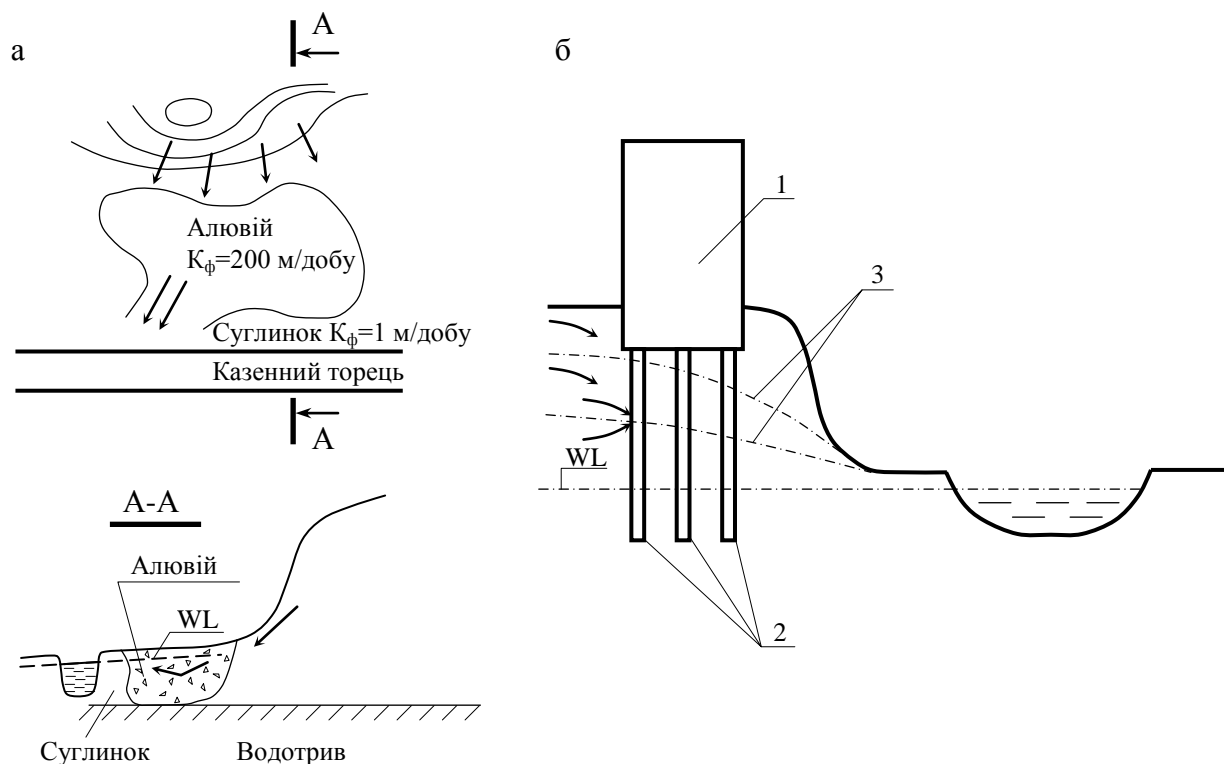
Схеми підтоплення територій: а – природного характеру; б – техногенного характеру (барражний ефект); 1 – споруда; 2 – пальові фундаменти; 3 – зміна рівня ґрунтових вод, зумовлена барражним ефектом
